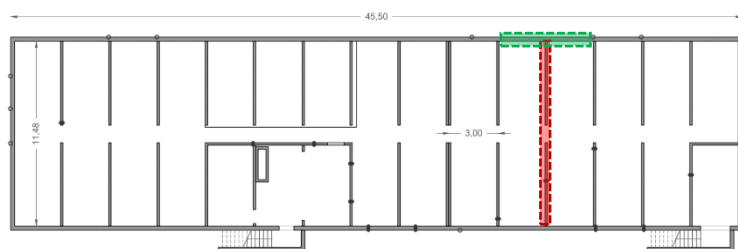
Bâti 6 - Plan de principe du sous-sol localisant les DDC estimée au droit d'un refend (en rouge) et d'une façade (en vert)
